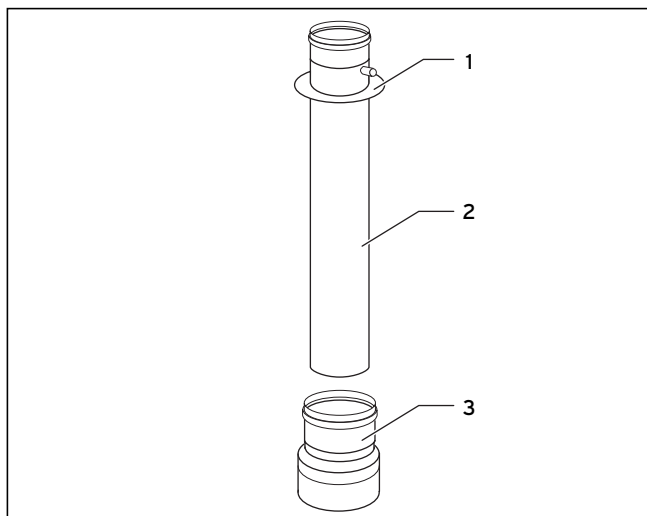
Монтаж подсоединения газоотвода (арт. № 303 970)
